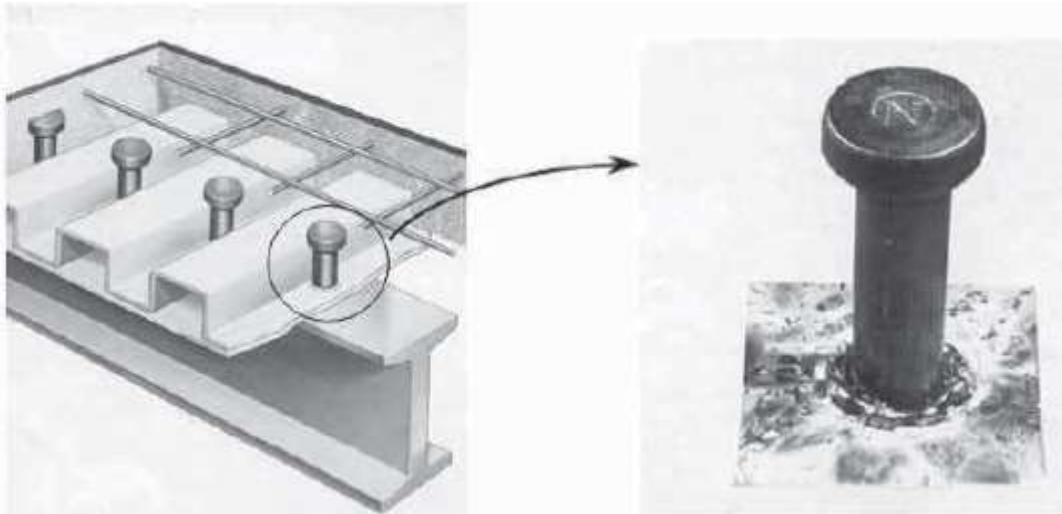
Ligação viga IFB com laje por meio de barras de aço
